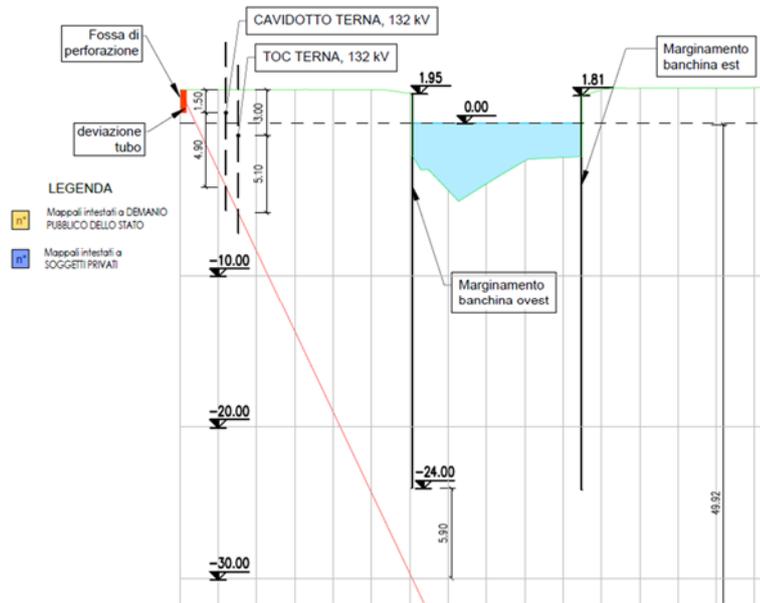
Sezione – dettaglio ingresso Ovest su via Galvani
